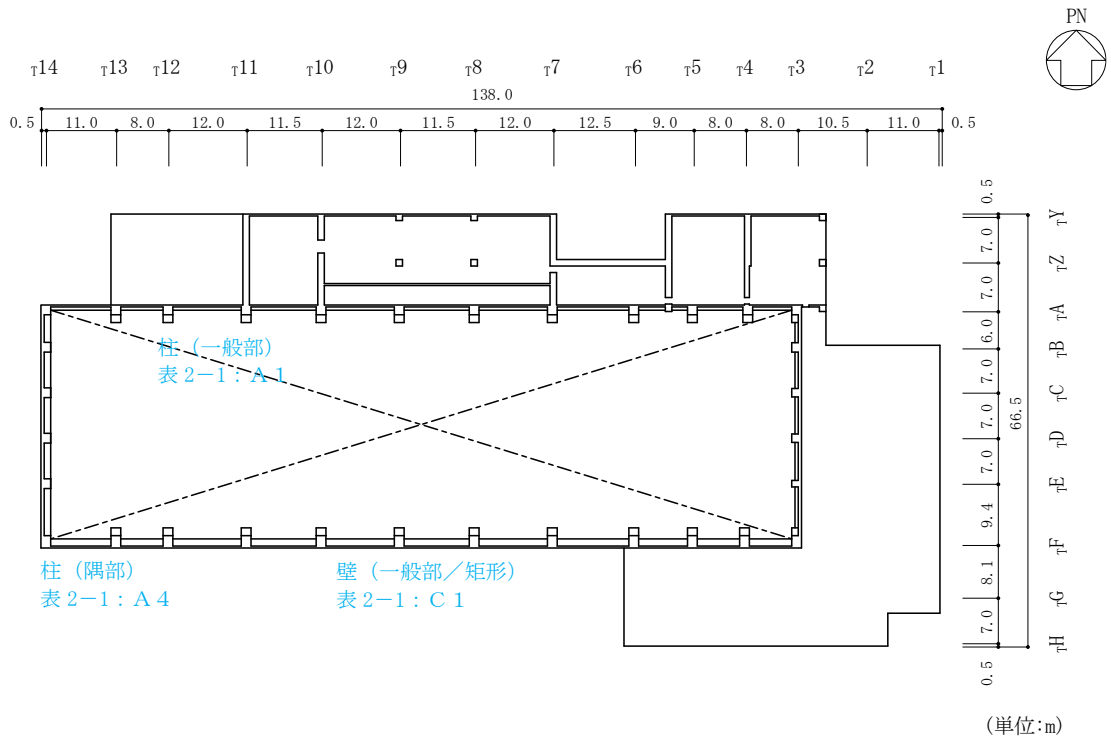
(5) タービン建物の概略平面図 (EL 32.0m)
